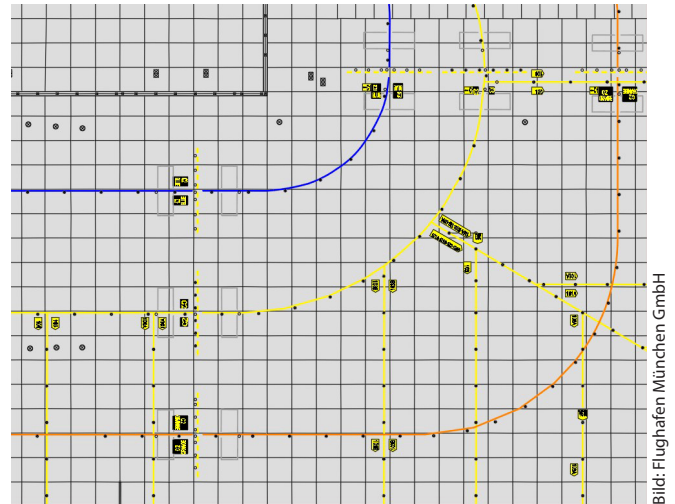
Rollweg C2 mit Betonplatten und Markierungen
